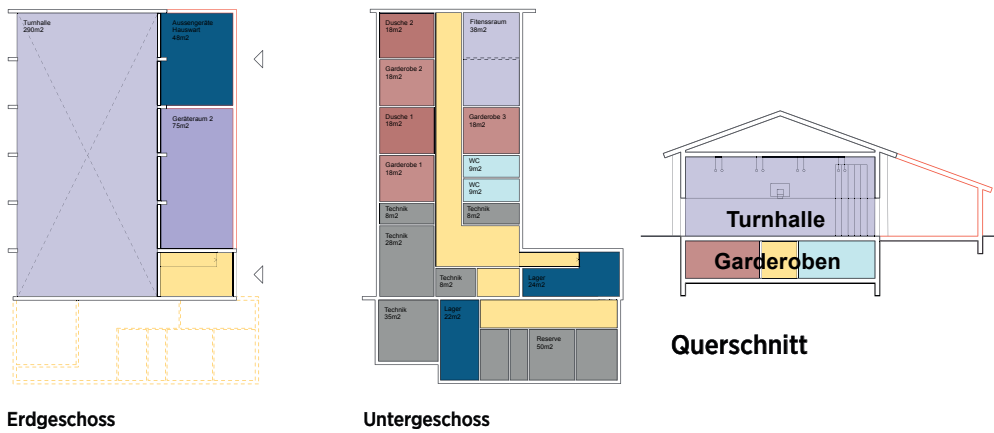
Grundriss Turnhalle Bestand (Bearbeitungsteam)
